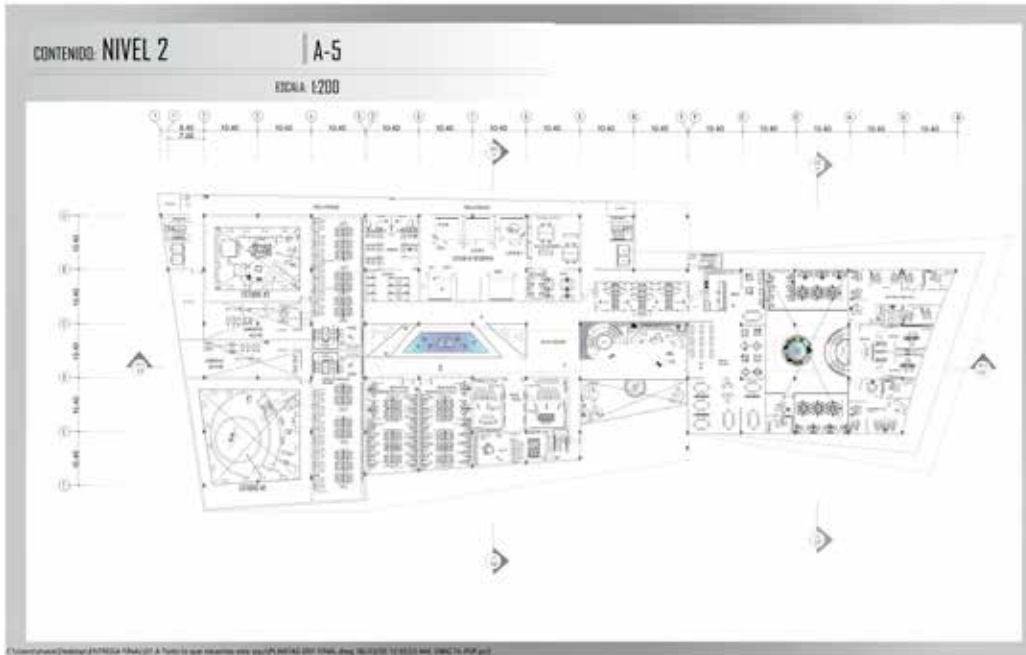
A5. Planta Nivel 2. Fuente: Navas. (20)
